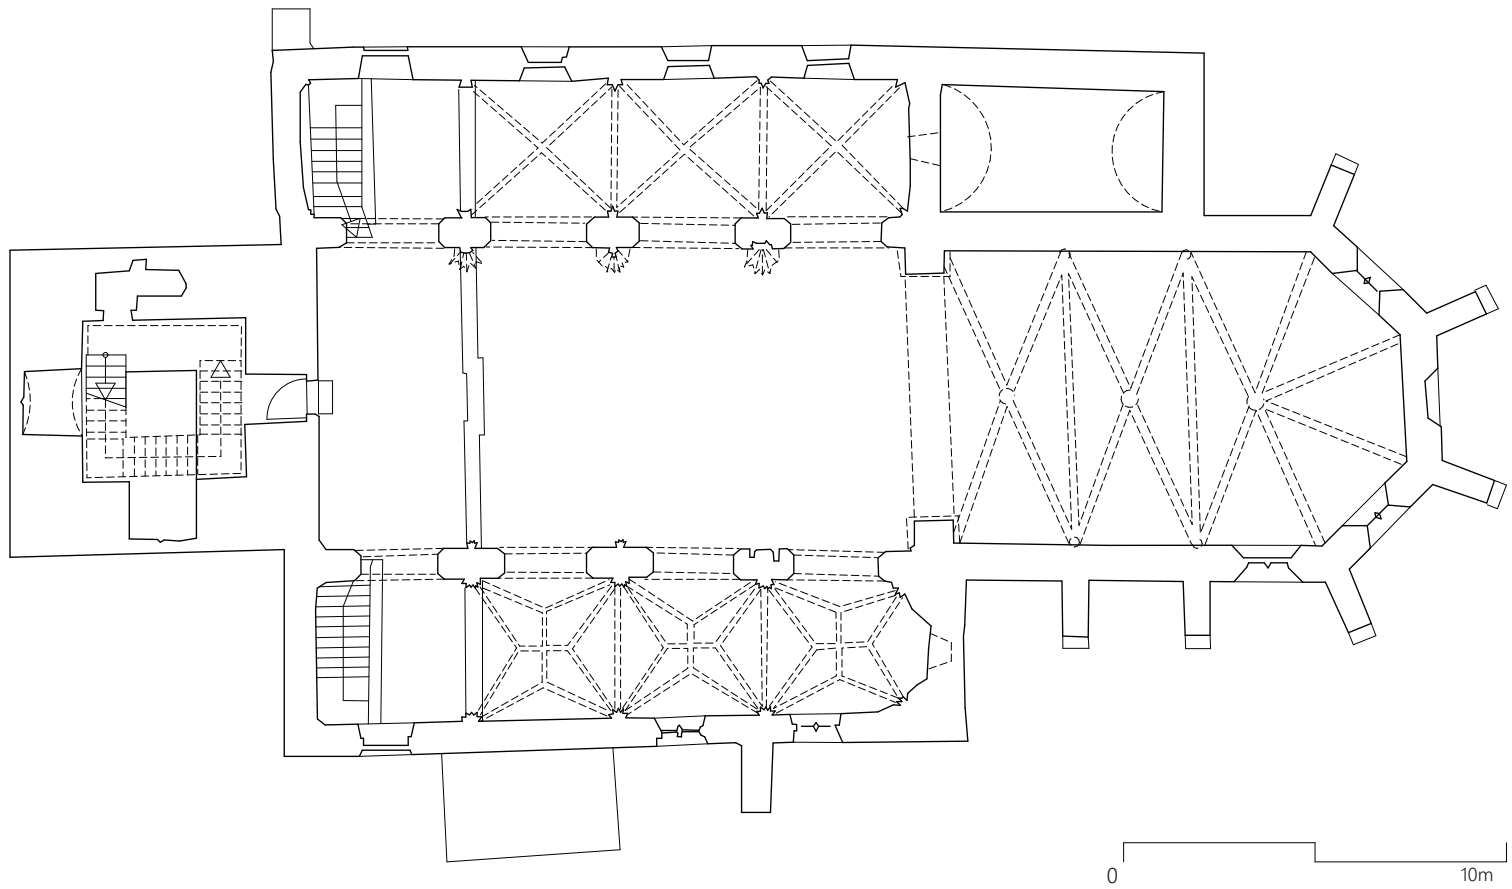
Grundriss Friedenskirche Döllersheim, Bauzustand 2017
